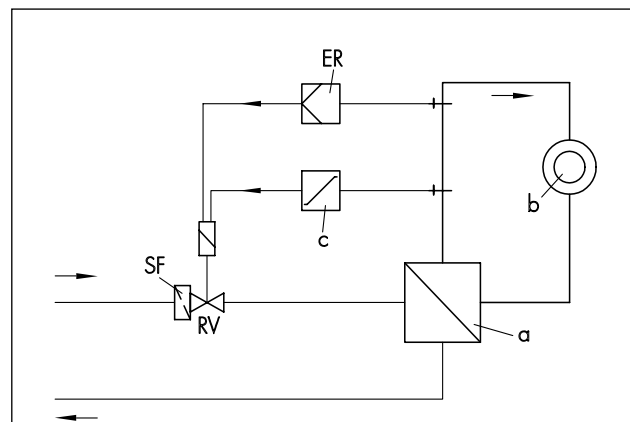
· Схема подключения для электрического регулирующего прибора типа 241-4
